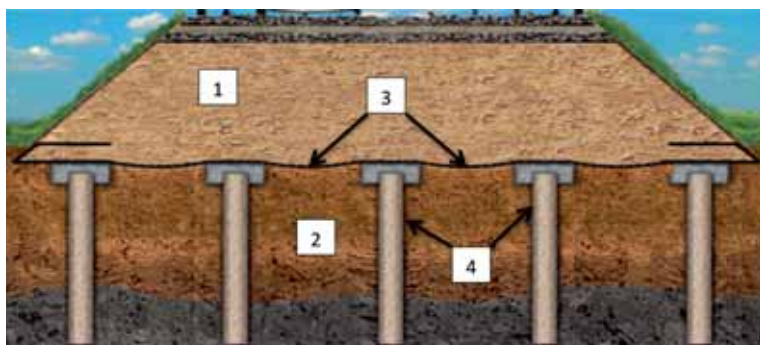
Принципиальная конструкция из вертикальных несущих элементов и гибкого ростверка для усиления основания насыпи, где: 1 – земляное полотно; 2 – толщина слабого грунта; 3 – геосинтетический материал (георешетка тканая или геополотно тканое на основе ПВХ или ПЭТ); 4 – сваи
